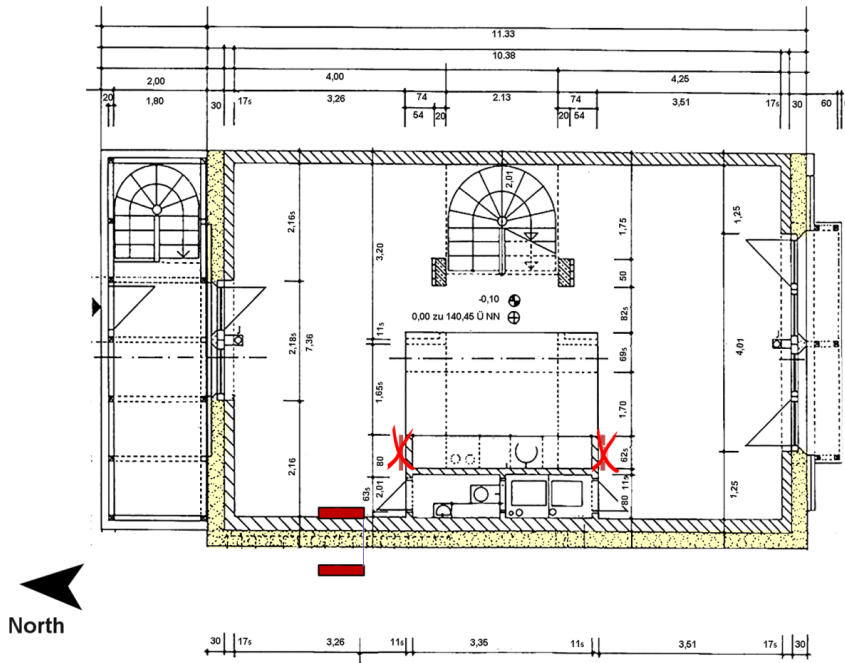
Grundriss des Erdgeschosses des Passivhauses Darmstadt Kranichstein mit der Lage der über 26 Jahre verwendeten Heizkörper (durchgestrichen) sowie der Position der 2016 neu montierten Luft-Luft-Wärmepumpe.
